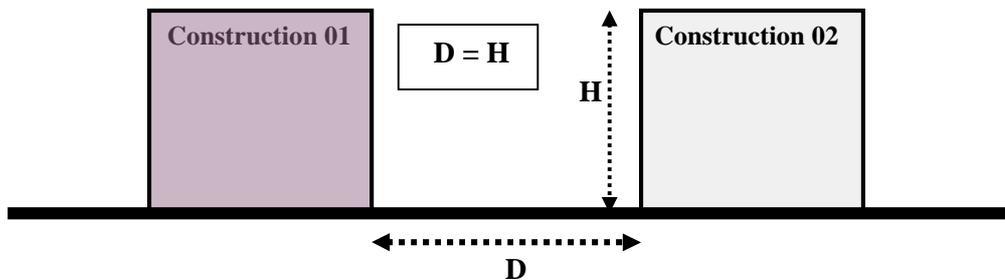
Coupe arrêtant la hauteur d'une construction en bordure d'une voie
